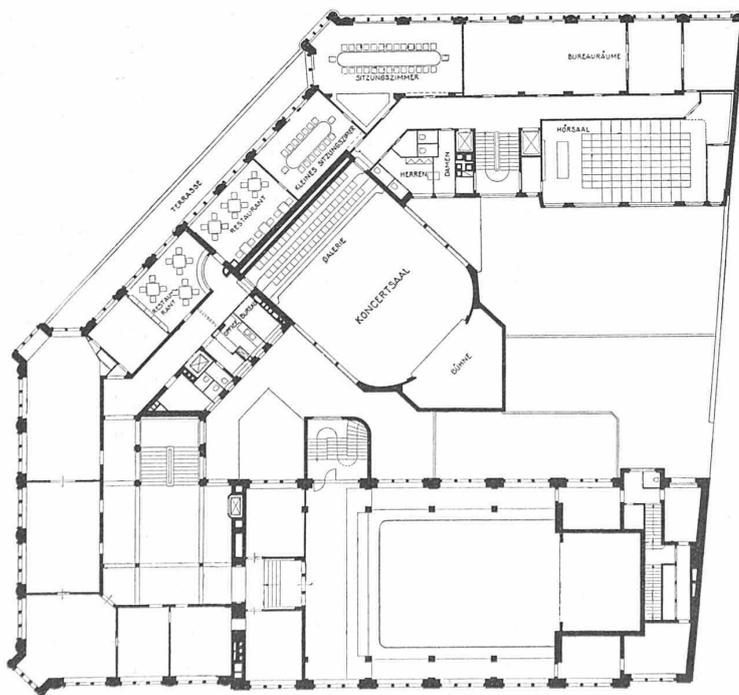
Grundriss vom ersten Obergeschoss (1 : 550; Cliché des K. V. Z.).
